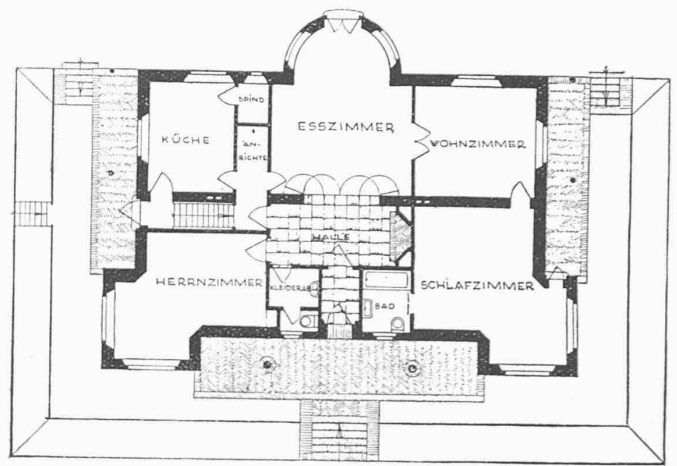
Haus Becker in Köln. Grundriss vom Erdgeschoss.
